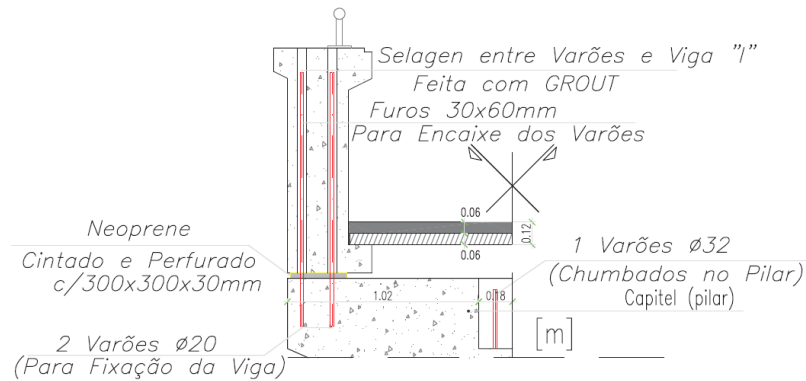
Pormenor da ligação entre a viga e o pilar do pórtico [33].
